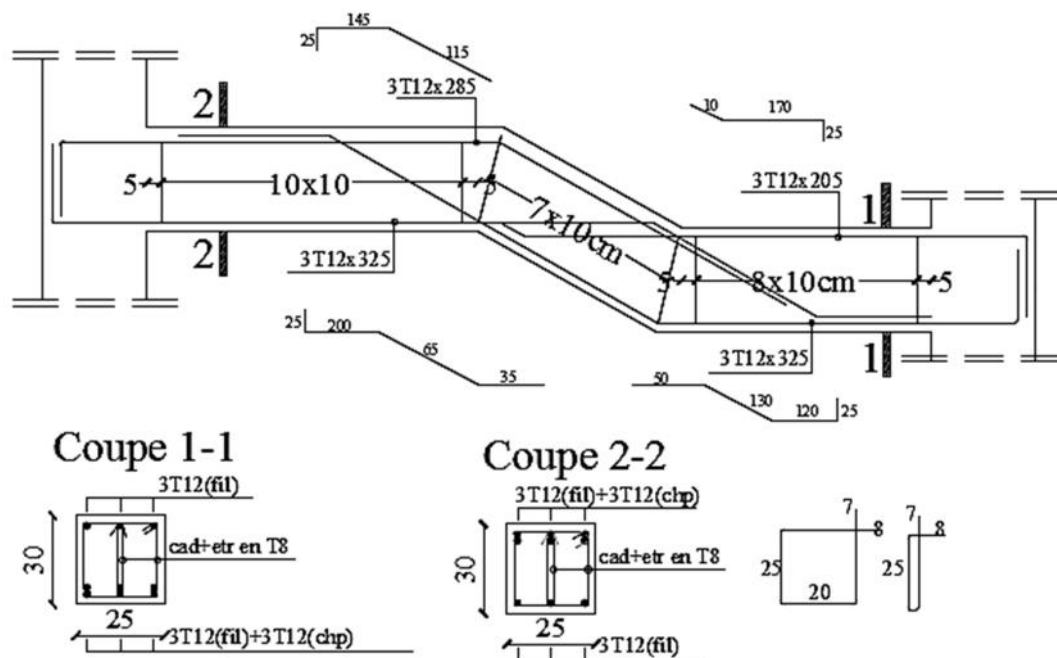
Ferrailage de la poutre palière des étages courants.
